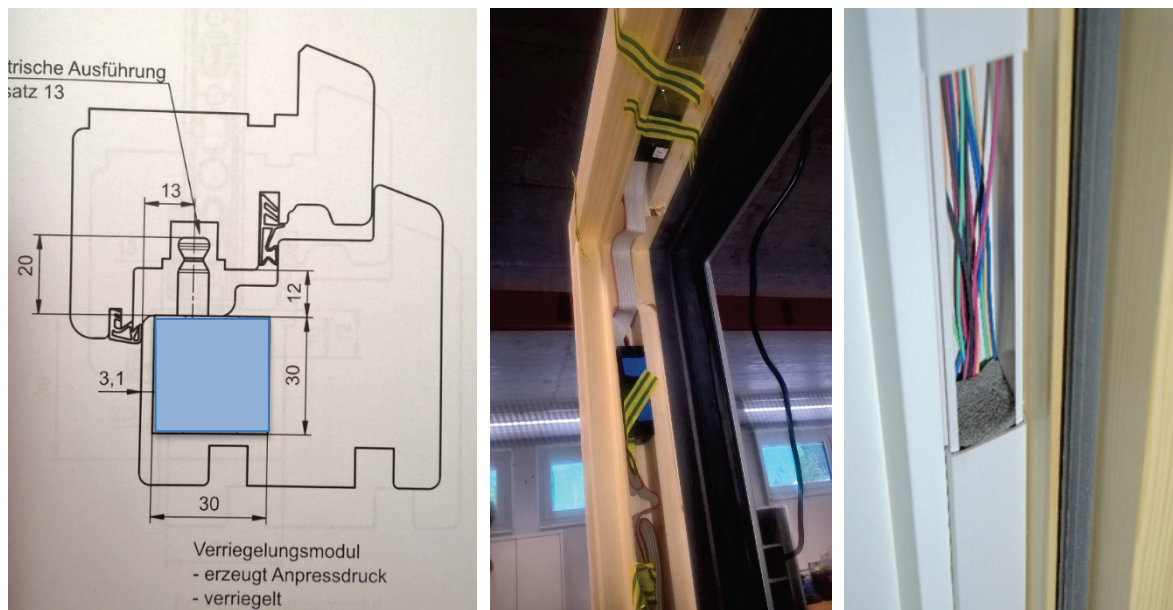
Prototyp B: Links, Zeichnung des Platzbedarfes für mechatronische Beschläge; Mitte, Ausführung der Fräsung für mechatronische Beschläge; Rechts, „Kabelkanal“ für mechatronische Beschläge (eigene Fotos des Projektkonsortiums FIVA)
